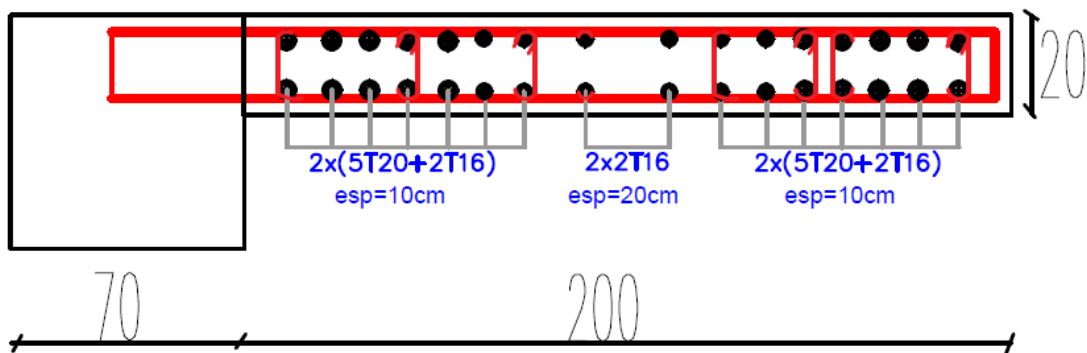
Schéma ferrailage des voiles (V9) coupes horizontales.
